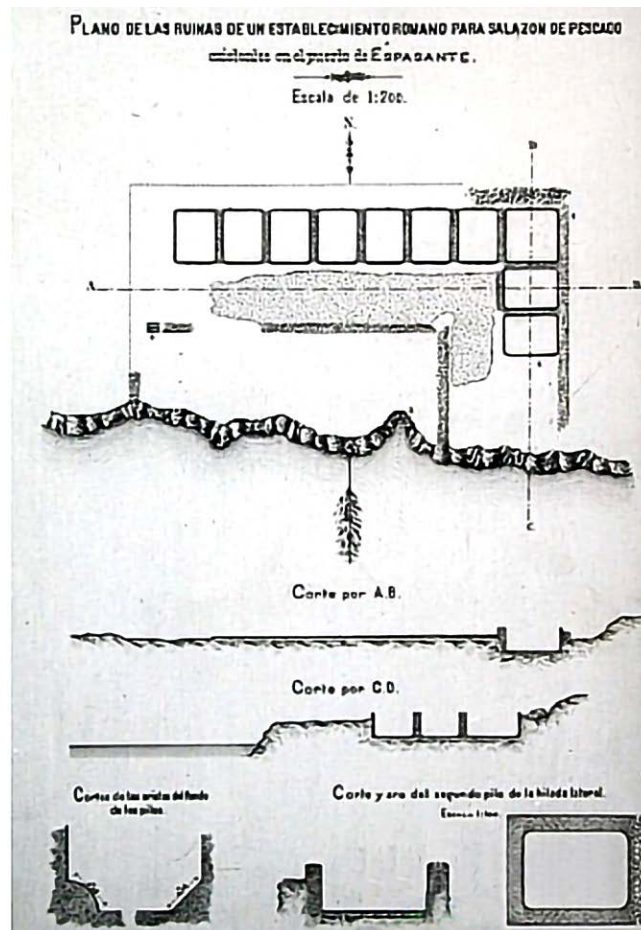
Planos y croquis de la factoría de Espasante (Maciñeira, 1947: 234)
